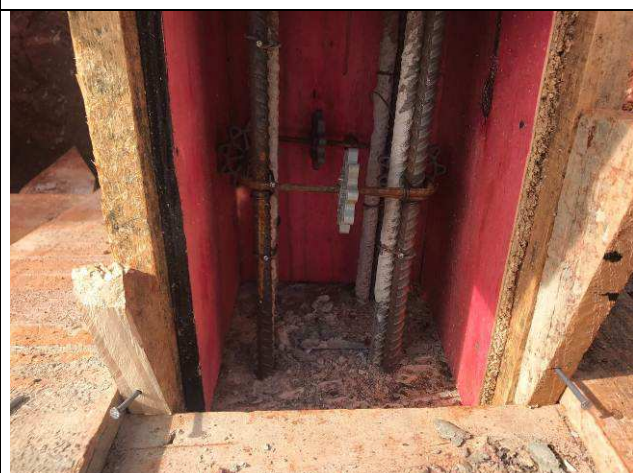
C: Formas e armaduras do pilar P78 do prédio principal.
